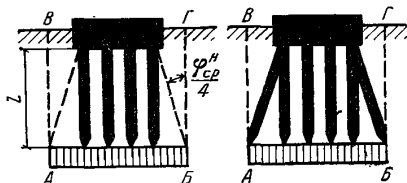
(1). Схема определения границ условного фундамента при расчете осадок свайных фундаментов
